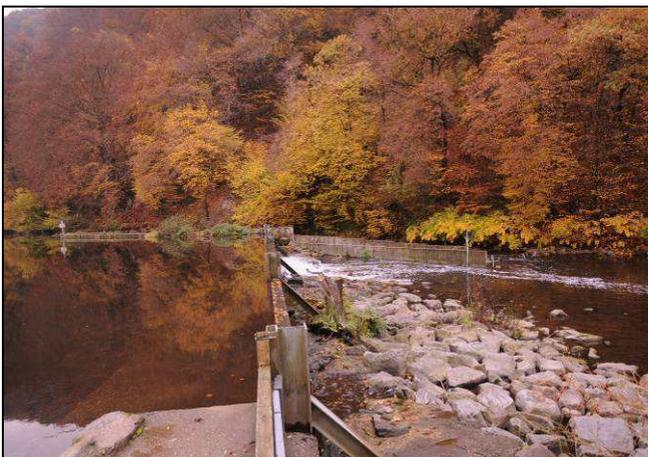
Ausleitungwehr mit Raugerinne-Beckenpass im Hintergrund
